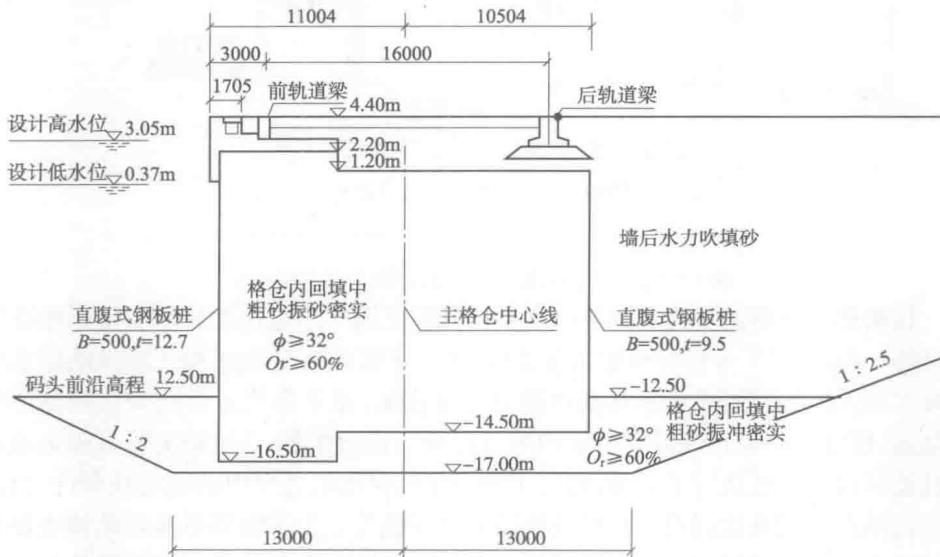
格形钢板桩码头结构断面图(尺寸单位:mm)
